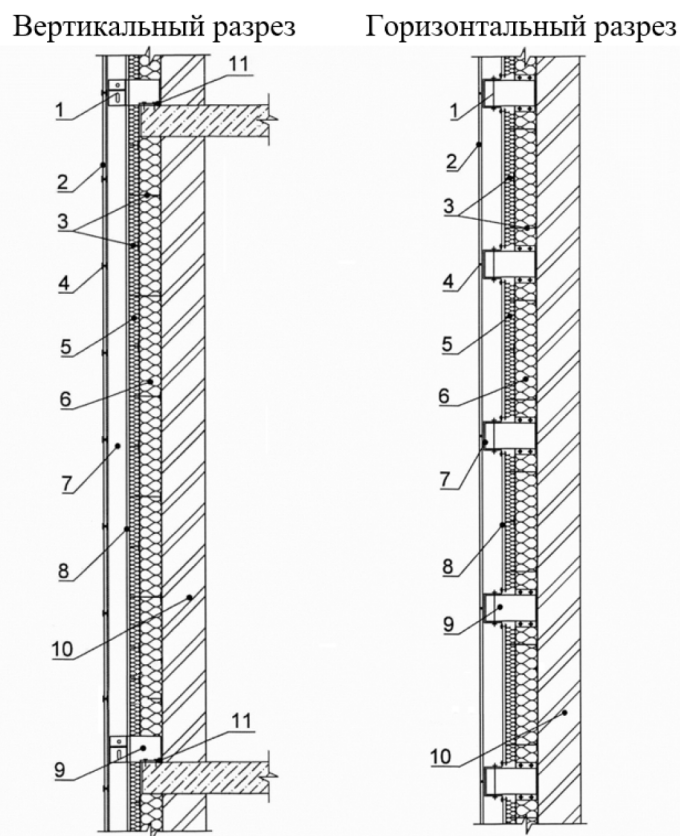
Предложенное конструктивное устройство системы вентилируемого фасада с креплением кронштейнов на краях плит перекрытий: 1 – самоконтрящиеся гайки; 2 – облицовочные материалы; 3 – дюбеля; 4 – крепежный элемент облицовочных материалов; 5, 6 – утеплитель; 7 – вертикальный направляющий профиль; 8 – огнезащитный экран; 9 – несущий кронштейн; 10 – стеновые материалы; 11 – паронитовая прокладка
